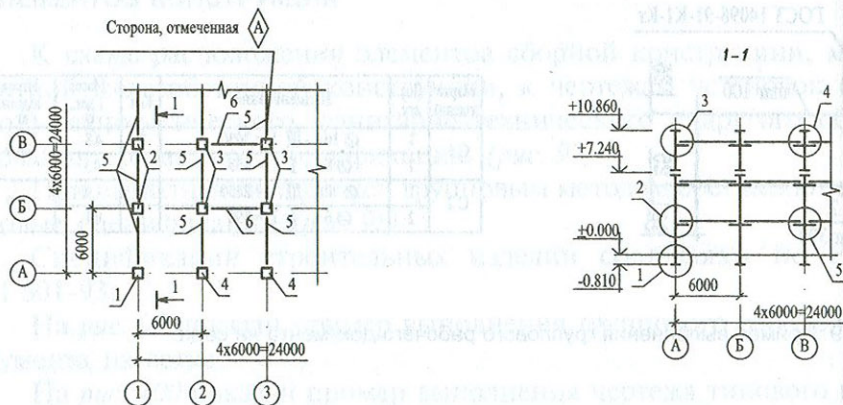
Схема расположения колонн, ригелей и балок перекрытия на отм. ...
